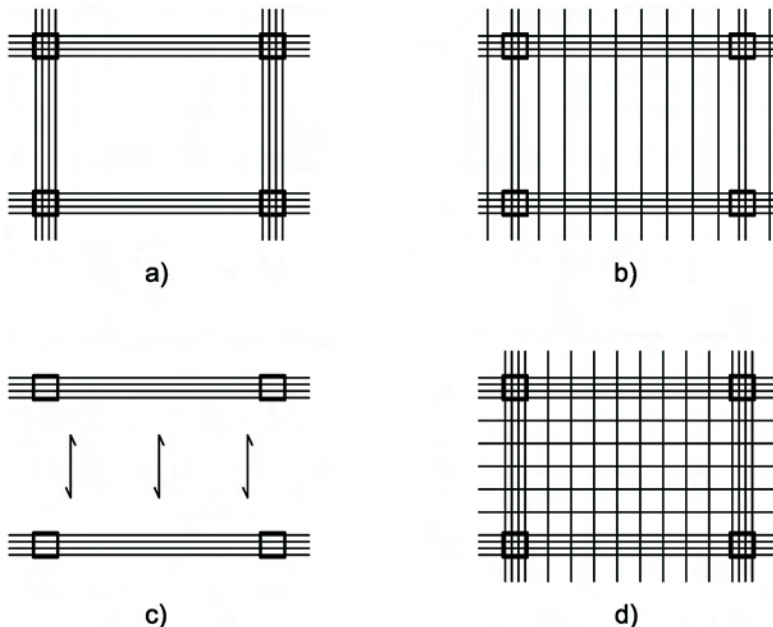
Distintas distribuciones de la armadura activa en planta.
